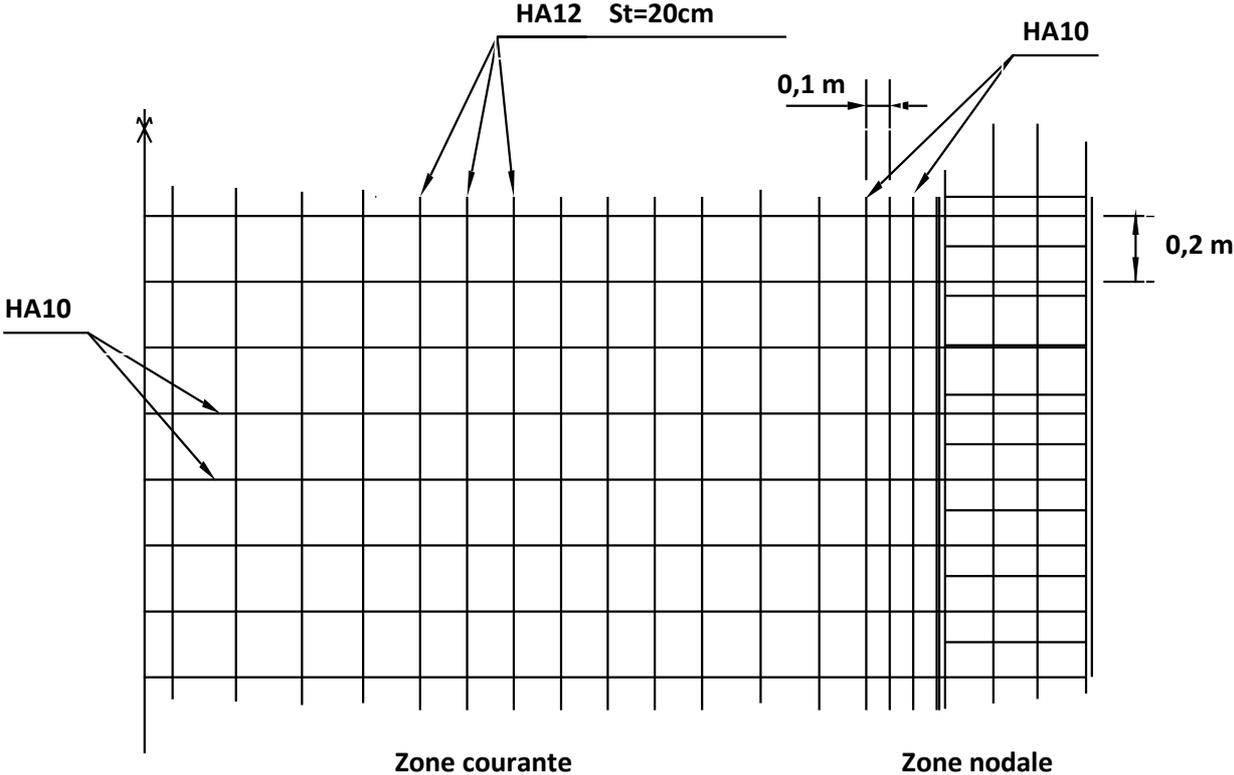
Schéma de ferrailage de l'ensemble voile poteau
